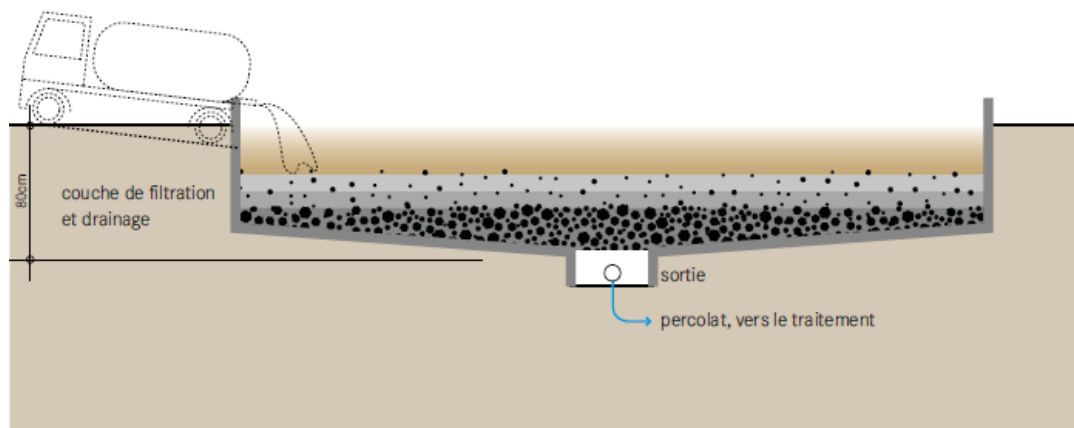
Coupe d'un lit de séchage non planté (Tilley, 2014).
